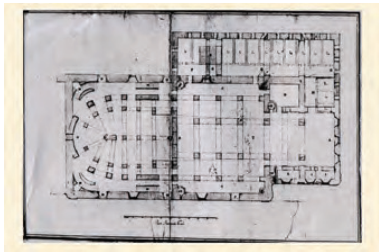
Real Teatro de Ópera do Tejo - planta do nível térreo, 1755, Academia Nacional de Belas Artes
